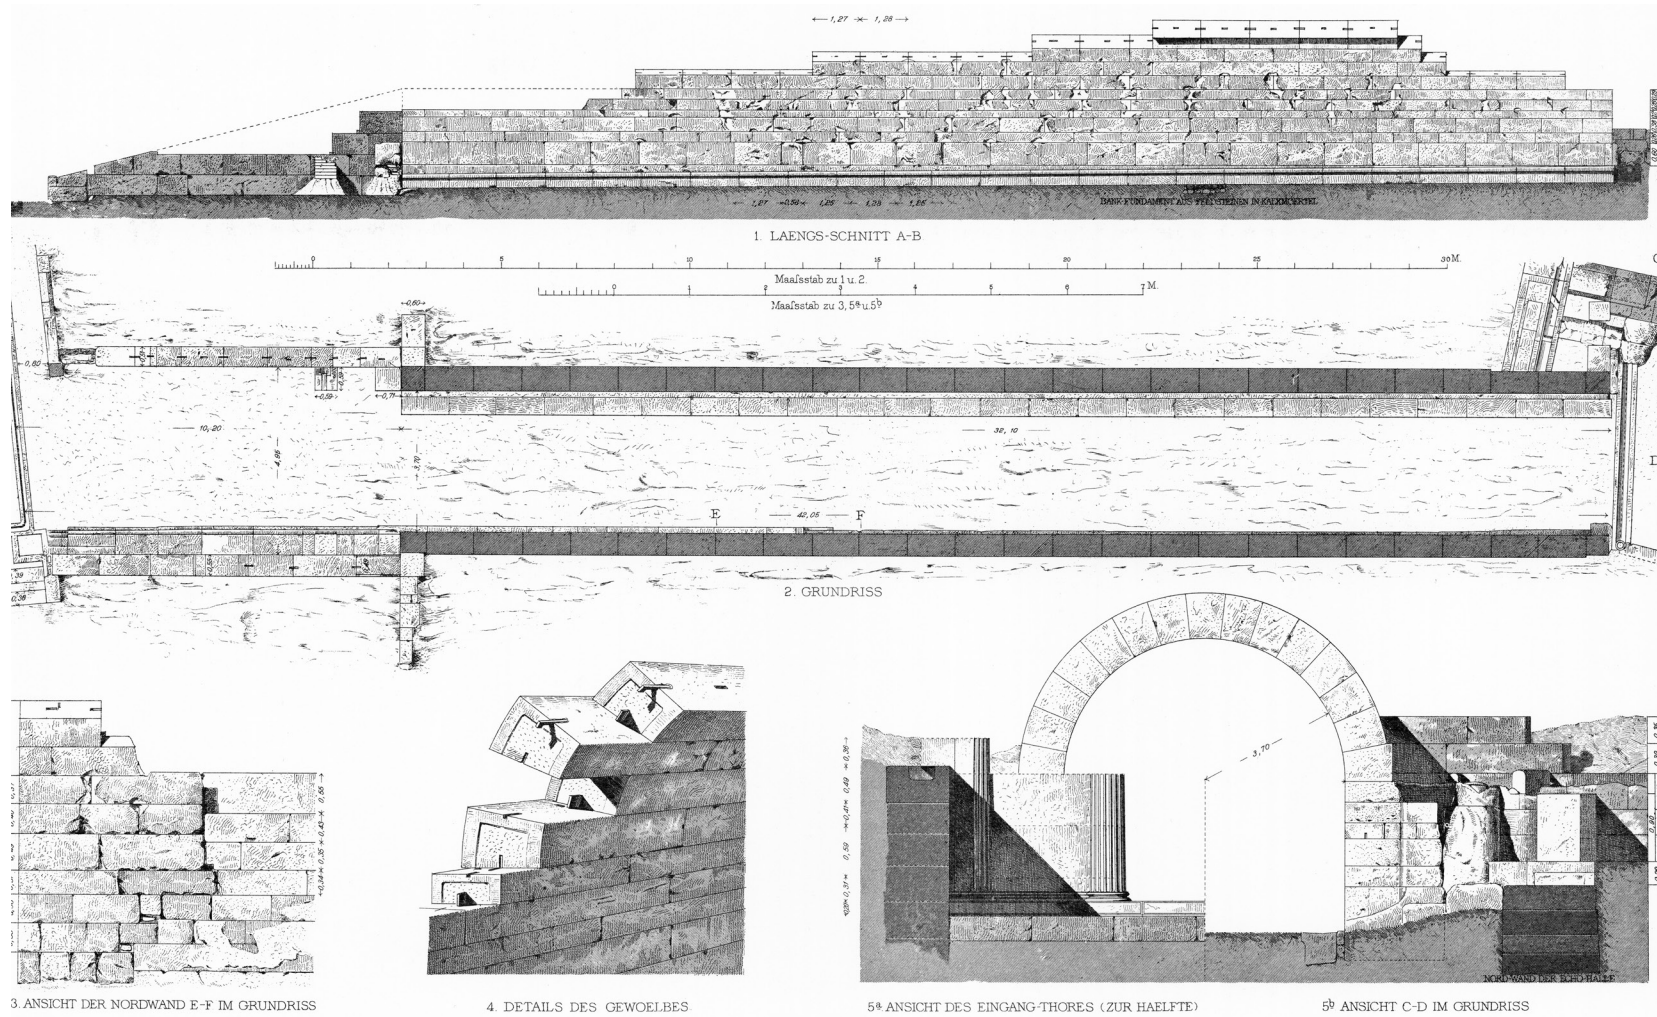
Grundriss, Längsschnitt und Aufriss des überwölbten Durchgangs durch den Westwall von Stadion III (M. Längen 1 : 200; M. Höhen 1 : 100)
